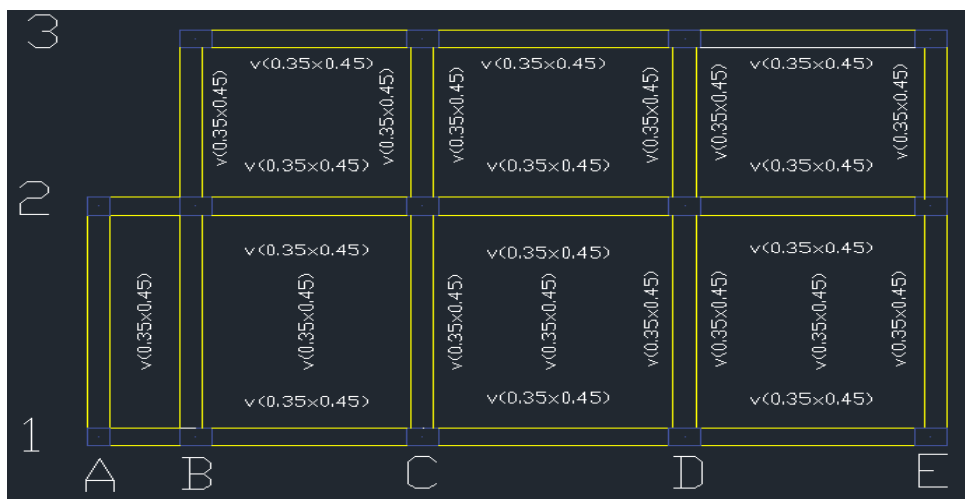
Plano en planta de vigas y columnas usando el programa AutoCAD 2020 para elaborar un diseño propio.
